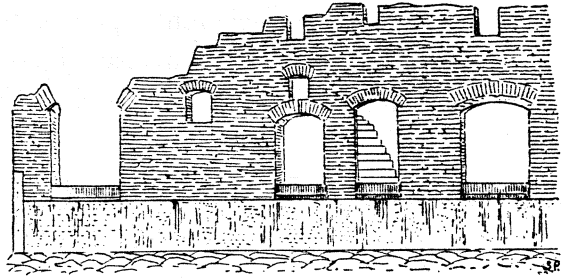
Facciata d'una casa con porte e finestre sino all'altezza del primo piano (Scavi 1906).
